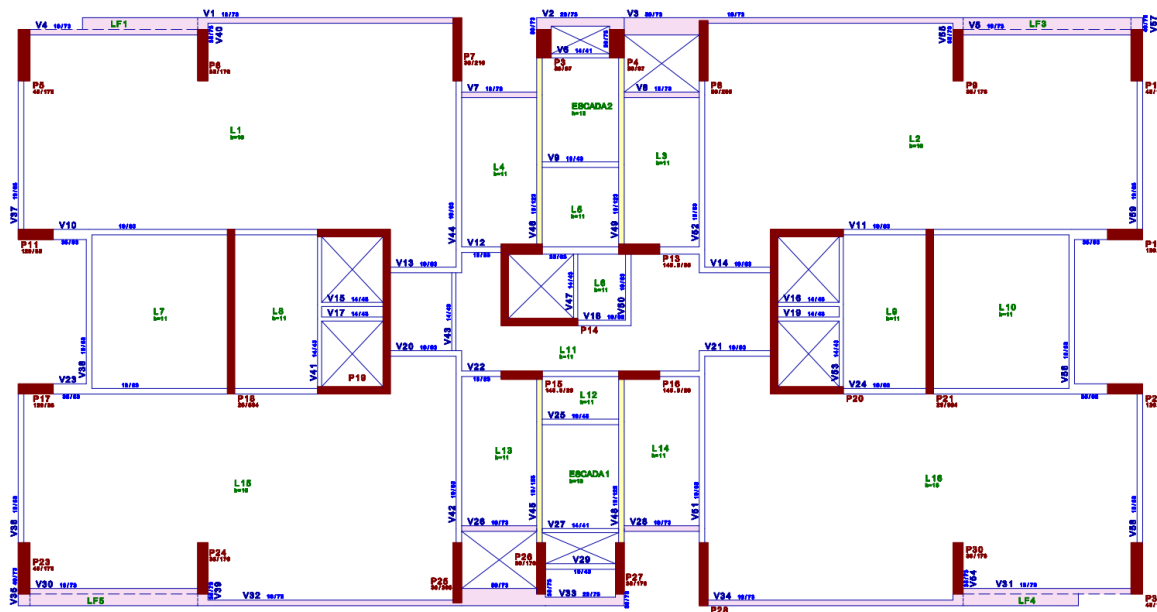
Planta baixa estrutural – Modelo 0 – Pavimento tipo
